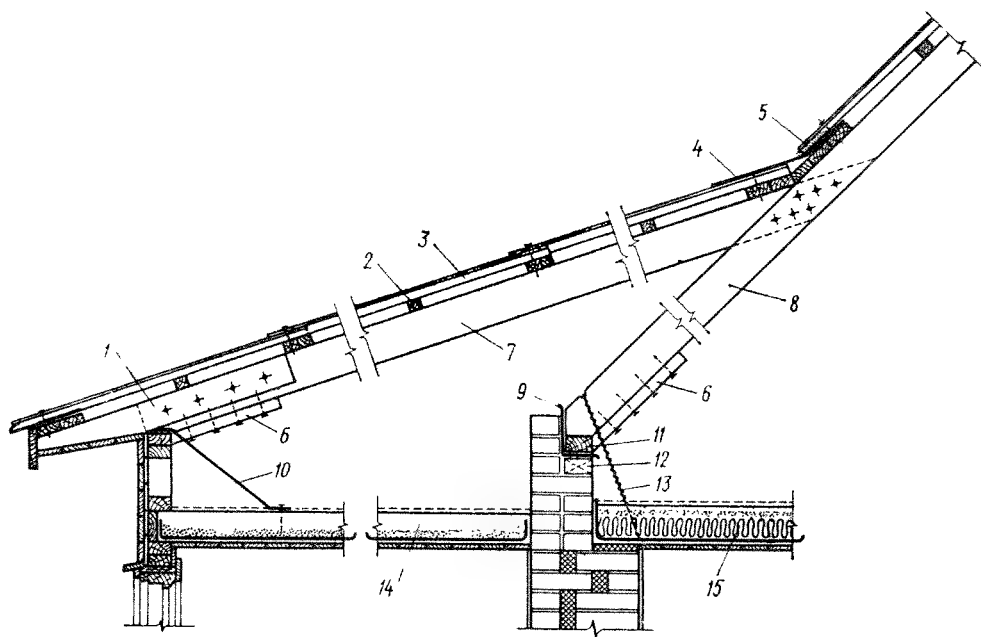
Крыша и чердачное перекрытие над верандой:
